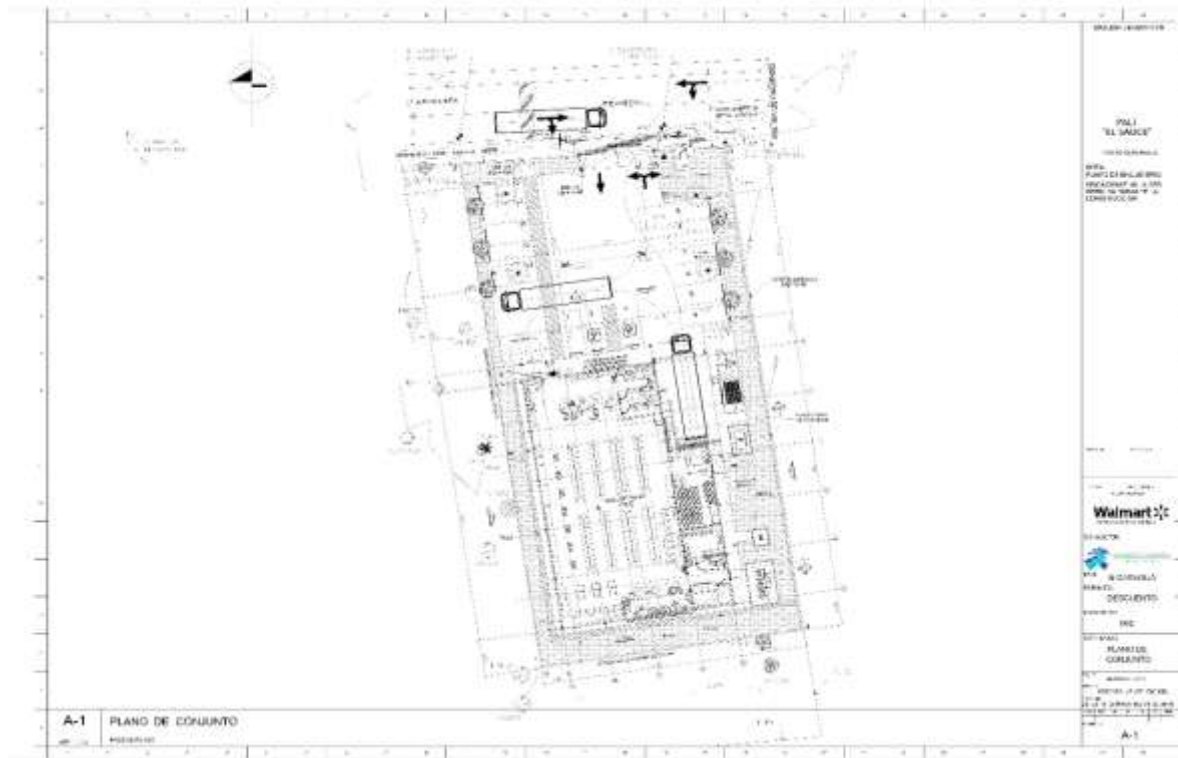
Plano de Conjunto del Anteproyecto Pali El Sauce, León. Fuente: Elaboración Propia.
